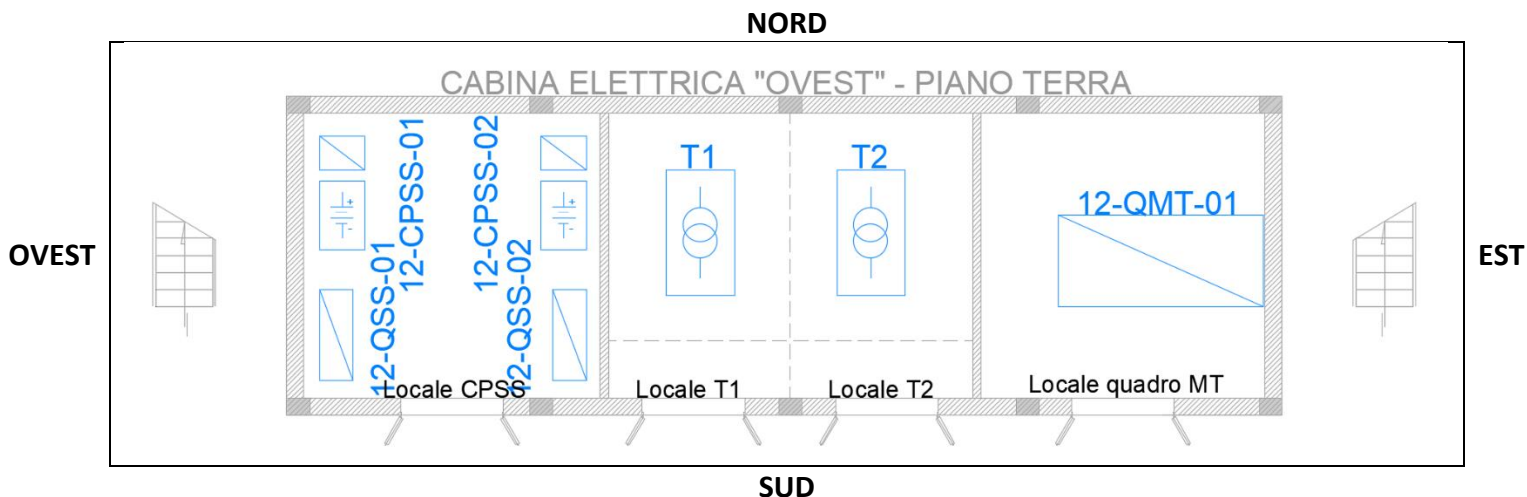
Pianta del locale Cabina MT/BT al piano terra
